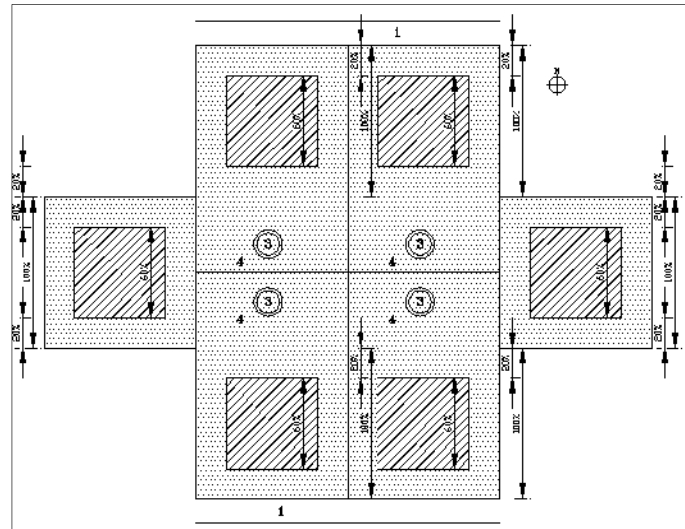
Schema der vorgeschlagenen Konstruktion der Hochhäuser: Oben: nördliches Grundstück, Unten: südliches Grundstück, Rechts und Links: westliches und östliches Grundstück
